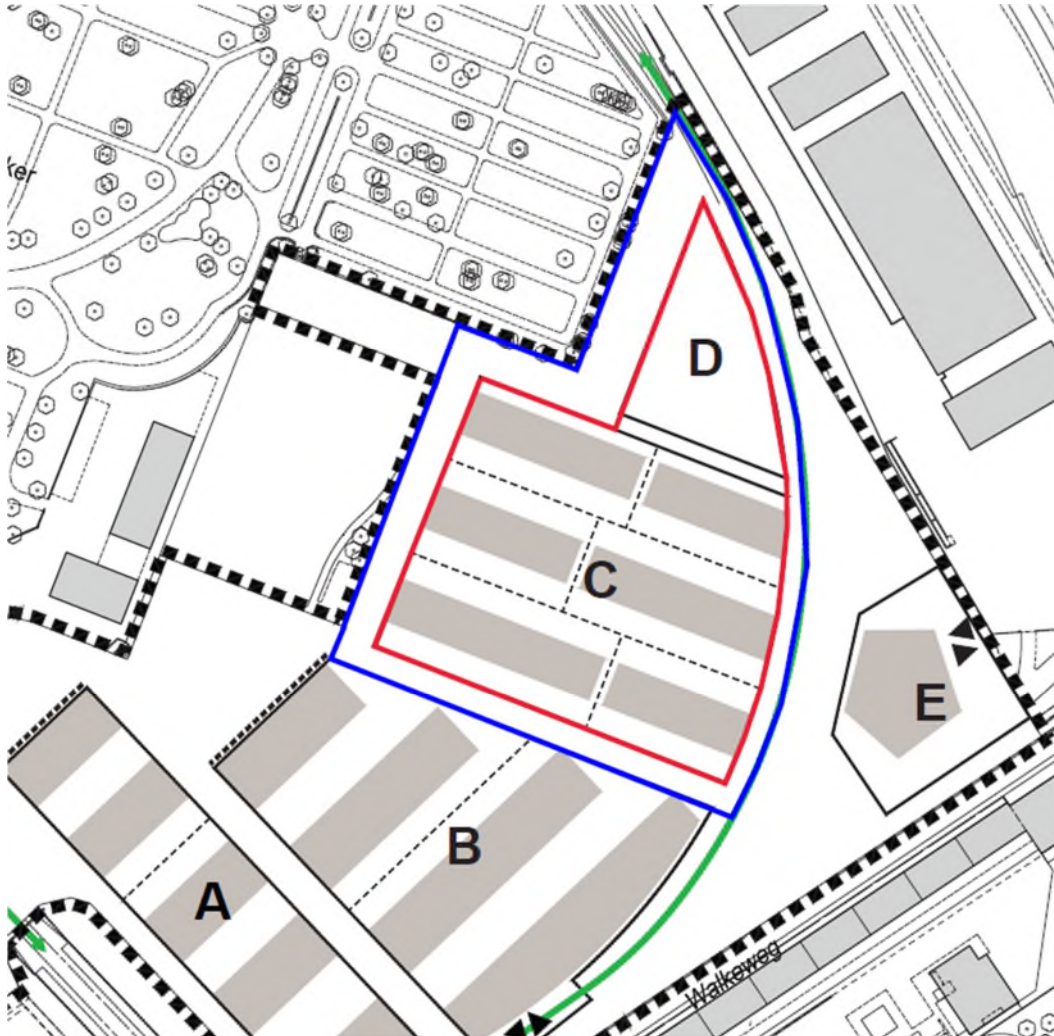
Darstellung Planungsperimeter (rot) und Betrachtungsperimeter (blau)
